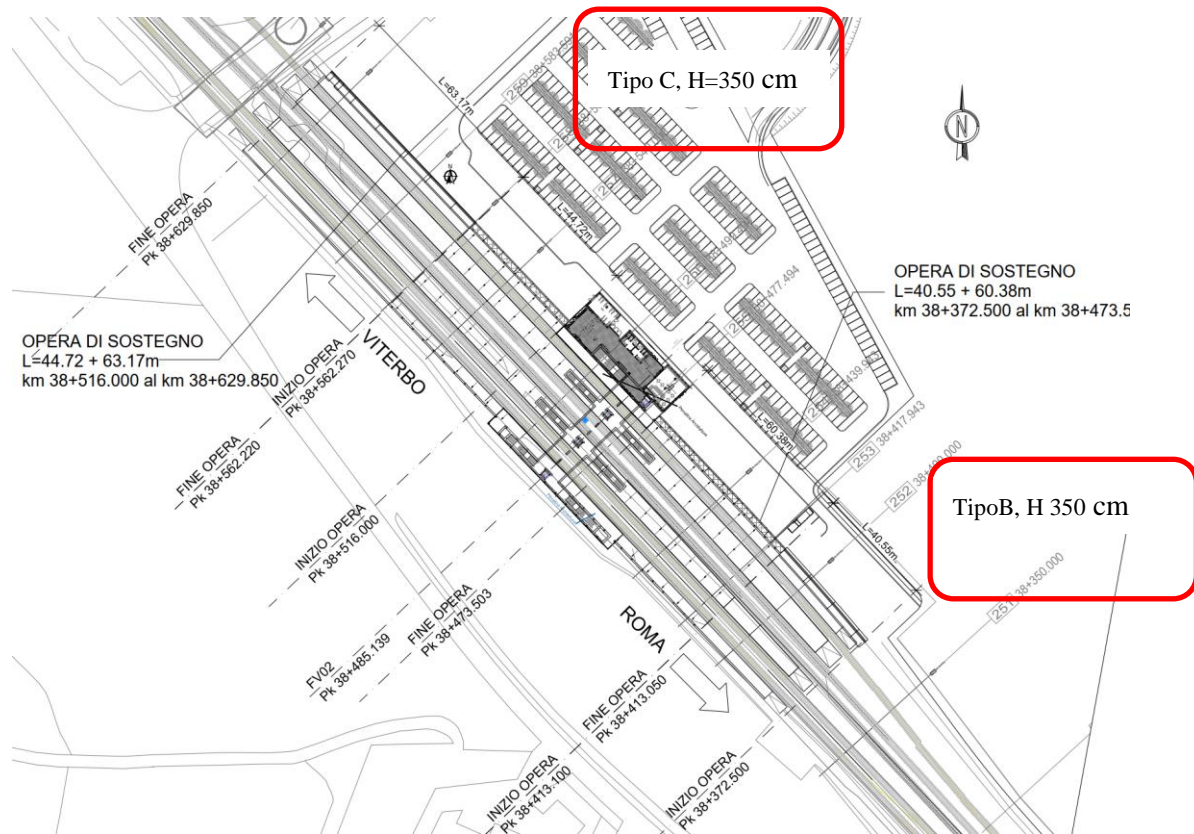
Planimetria muro di sostegno lato parcheggio
